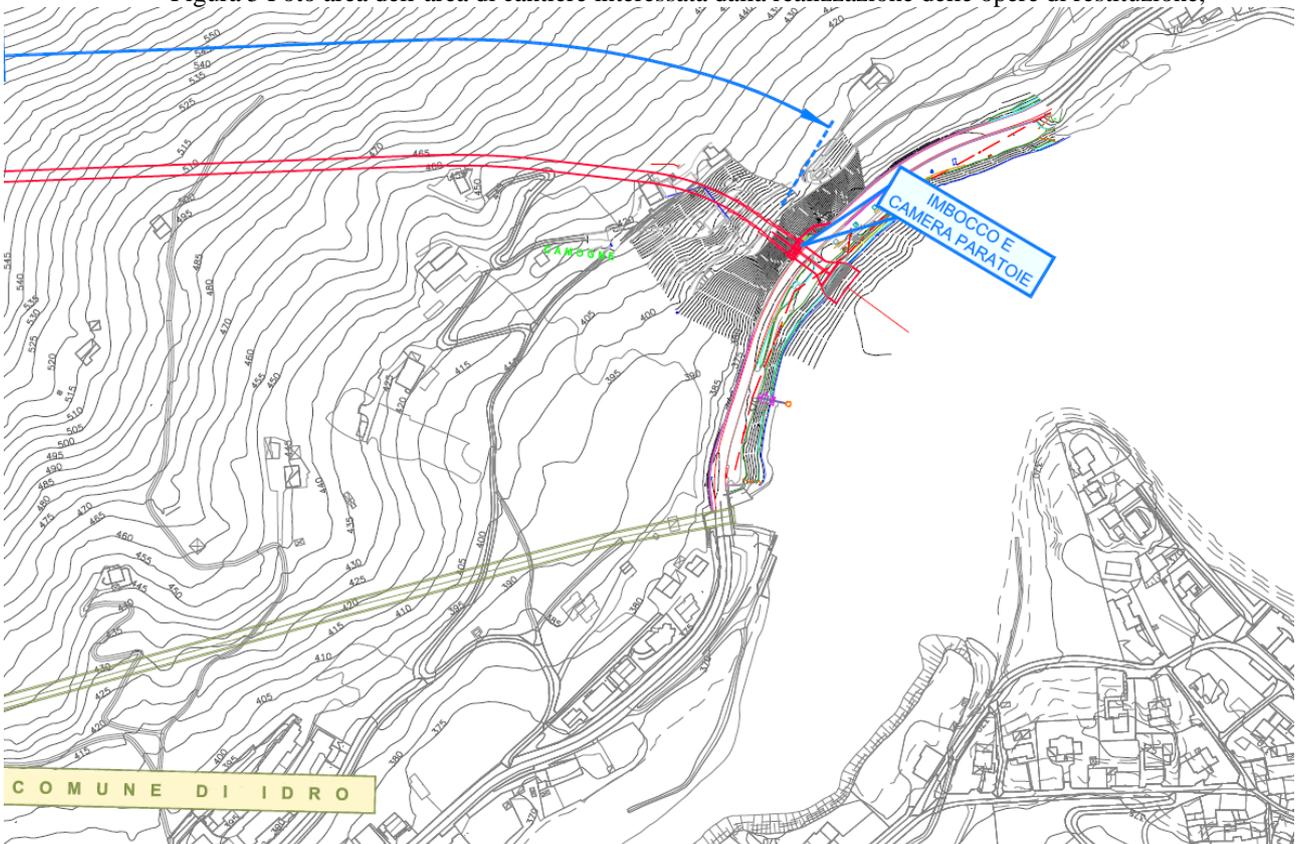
Localizzazione dell'area interessata dalla realizzazione dell'imbocco della nuova galleria.
